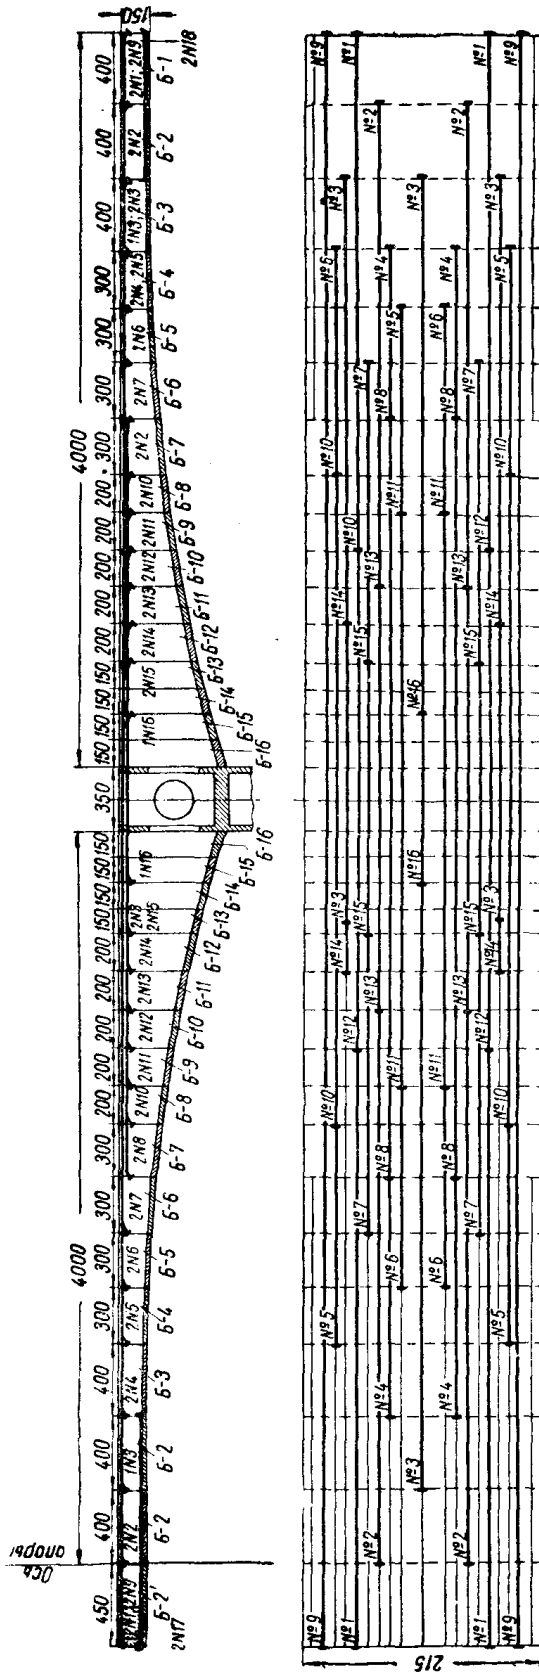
Расположение предварительно напряженной арматуры и схема членения пролетного строения 4,5 + 40 + 80 + 40 + 4,5 м на блоки
